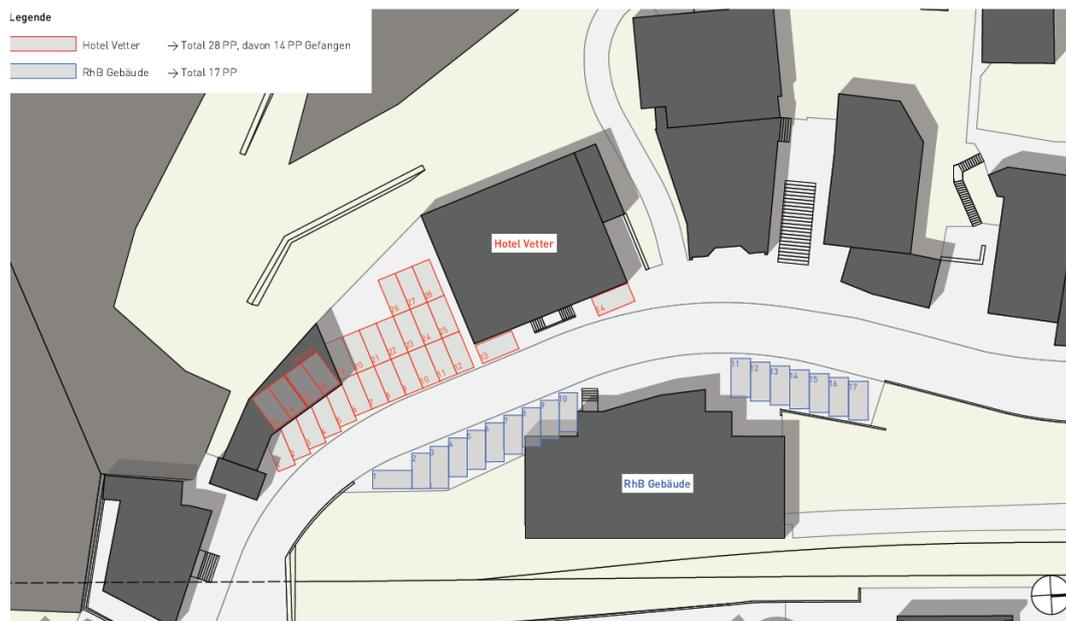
Parkierungsnachweis, Situationsplan Bestand, Fanzun AG
